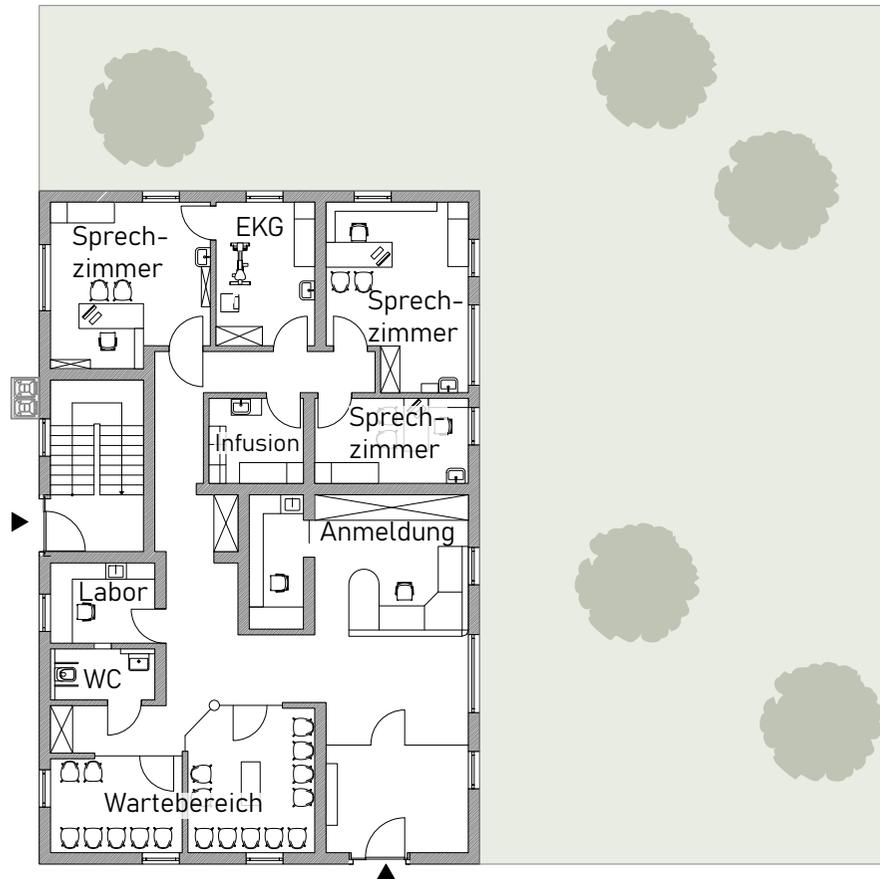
Grundriss Erdgeschoss 1:200
